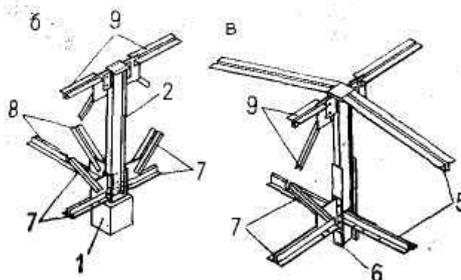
Сопряжение стальных стропильных и подстропильных ферм
